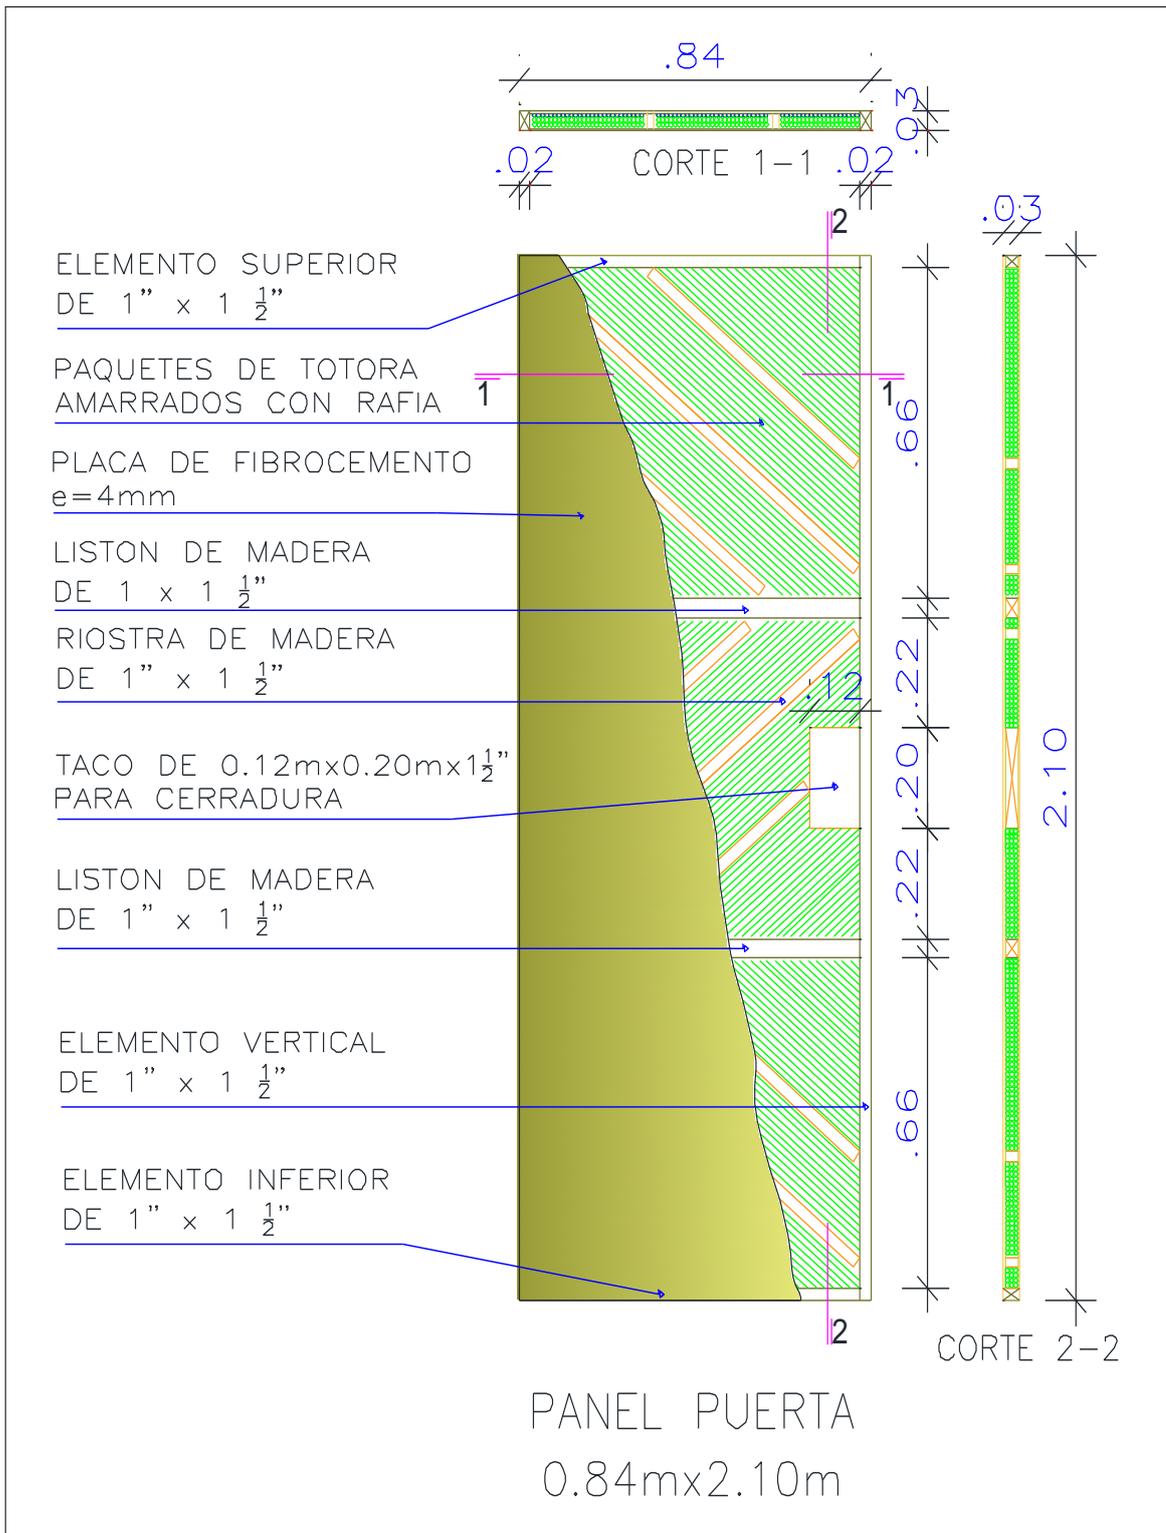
Panel puerta 0.84 m x 2.10 m del sistema constructivo propuesto
